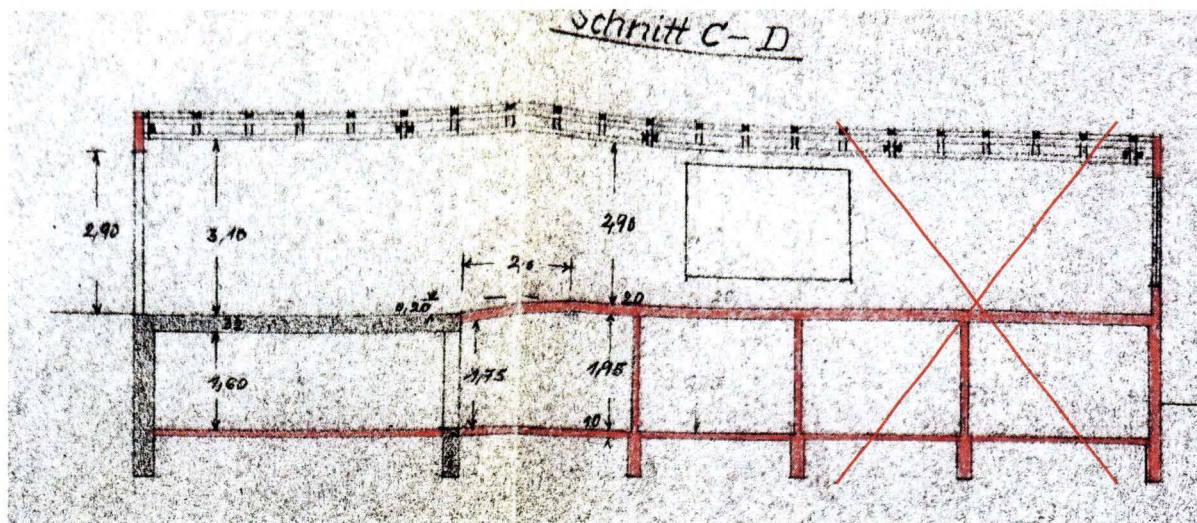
Schnitt Garagen 6 und 7 sowie Halle 1
